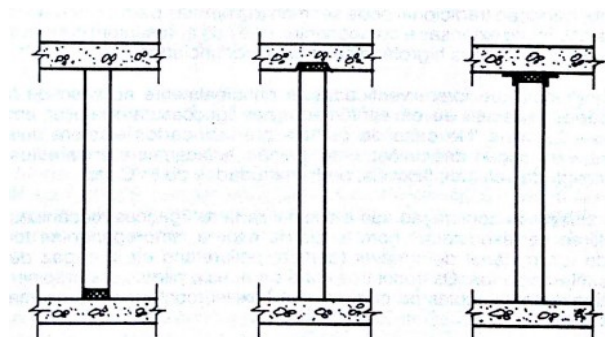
Junta de dessolidarização entre a parede e a estrutura.
